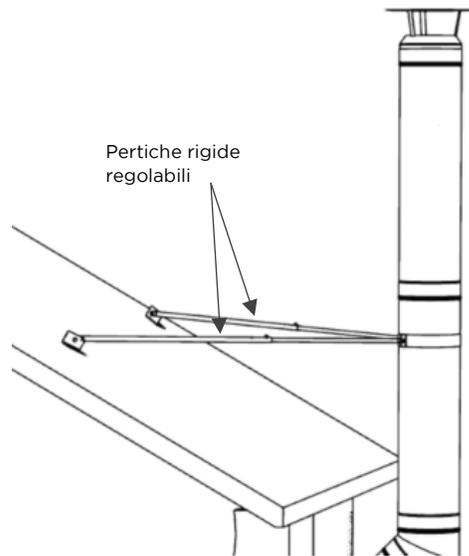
Fascetta stabilizzante sopra tetto (191)
